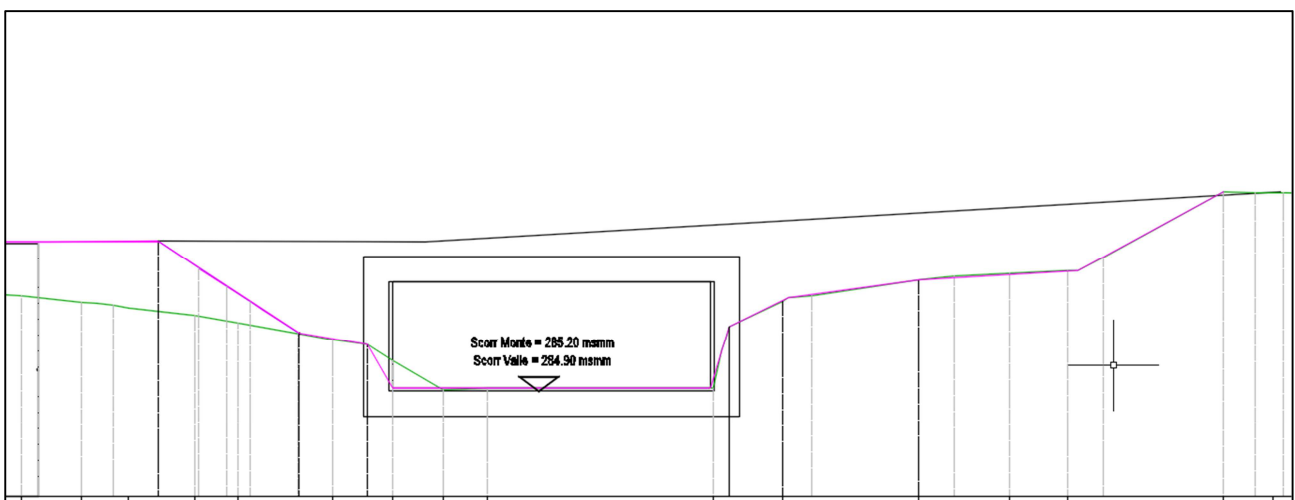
Manufatto di accesso cantiere – Sezione Trasversale
